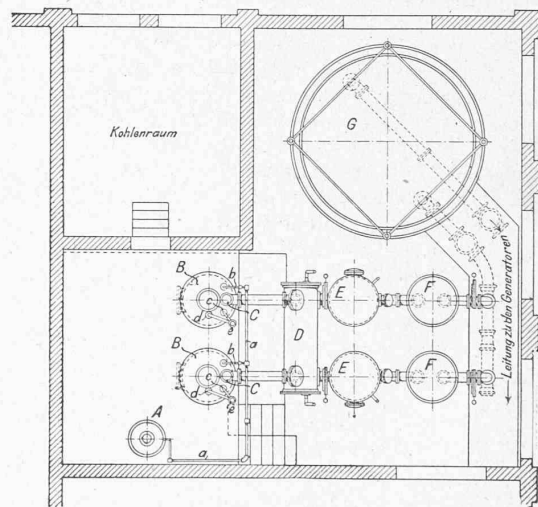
Grundriss. — Masstab 1:150.
